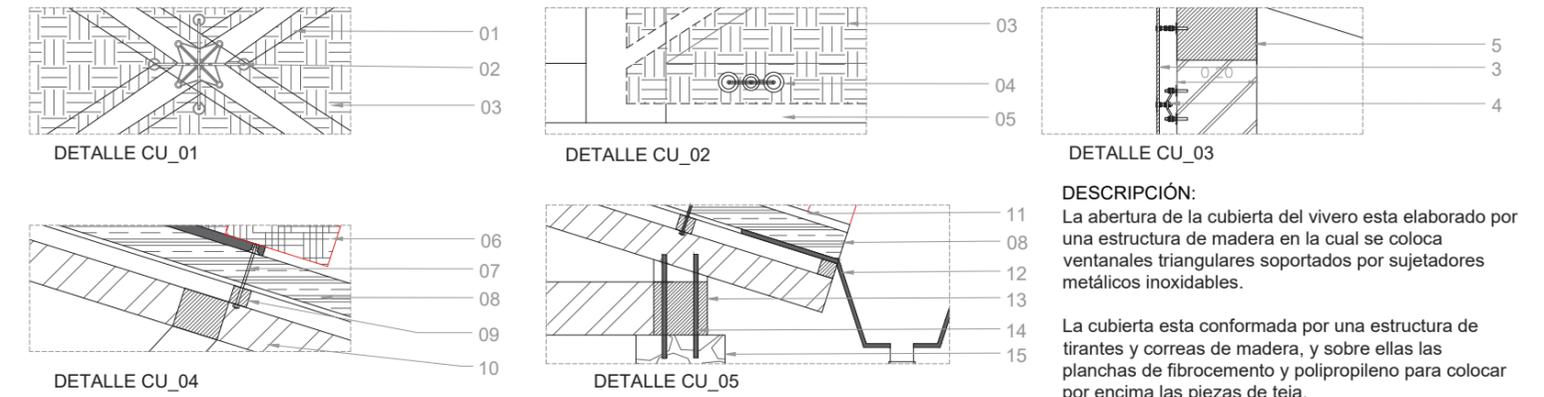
SECCIÓN DE DETALLES DE CUBIERTA
